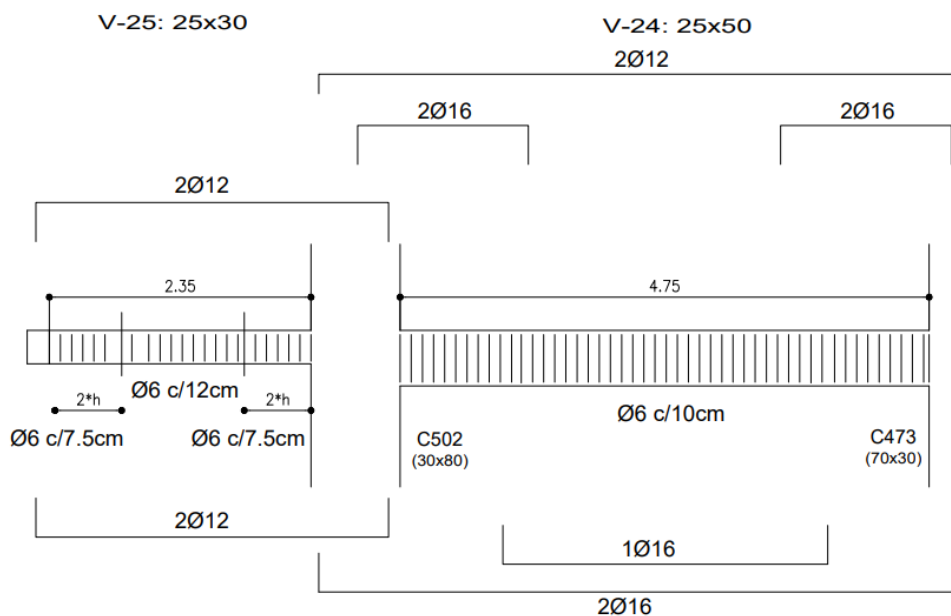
Esquemas de armaduras - Vigas 24 y 25
